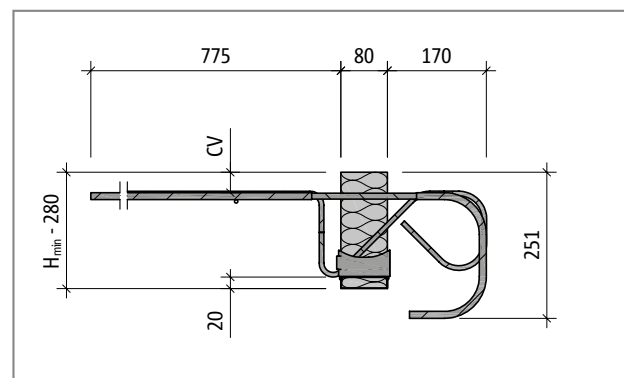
Schöck Isokorb® tipo K70M-UZ – K110M-UZ: Sezione dell'elemento
